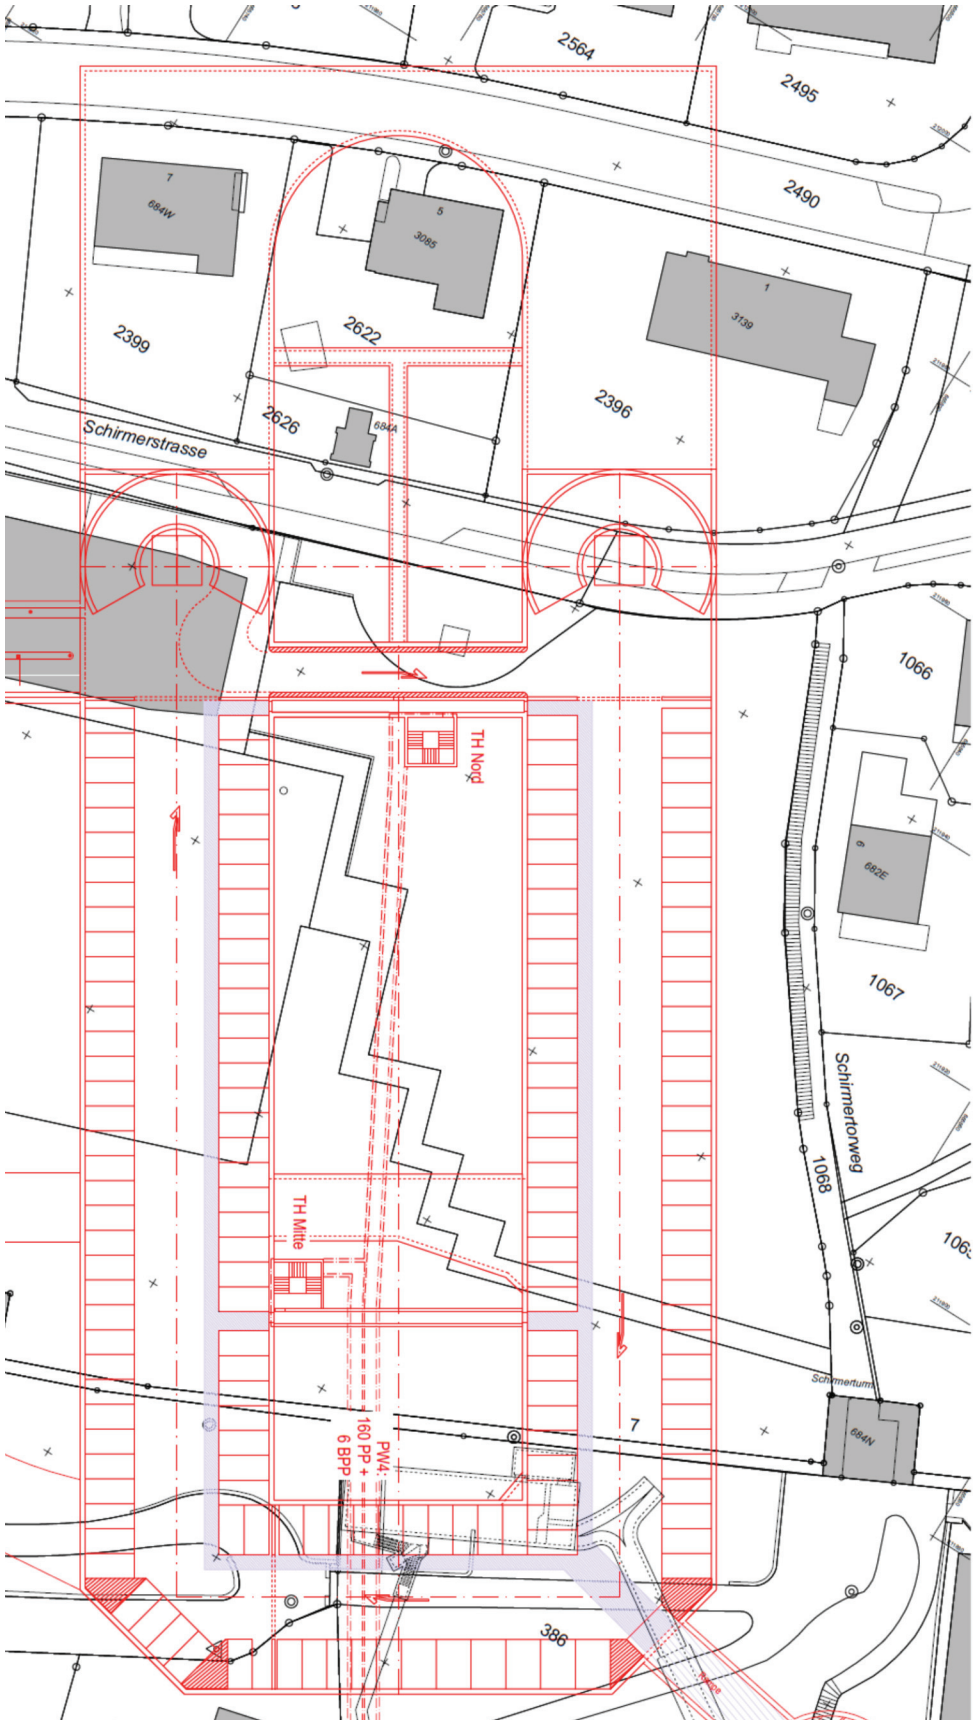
Grundriss PW-Parkgeschosse 1-4
